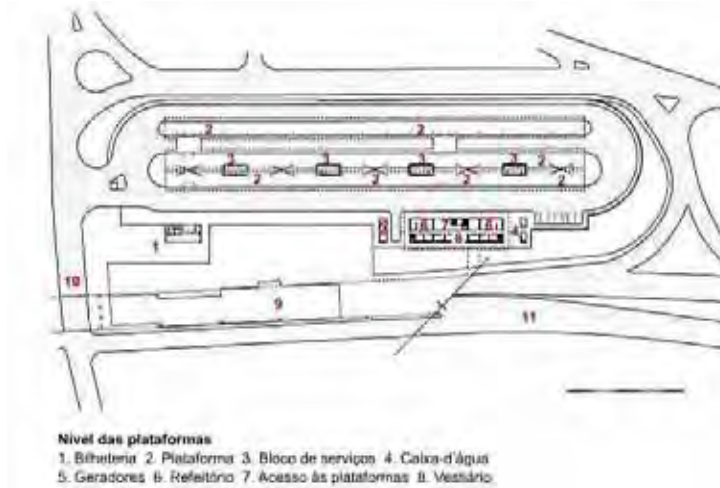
Planta baixa. Fonte: www.arcoweb.com.br
